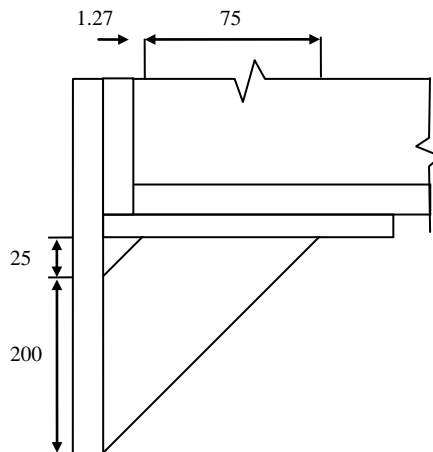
Dimensiones de la placa, acotaciones en mm.
